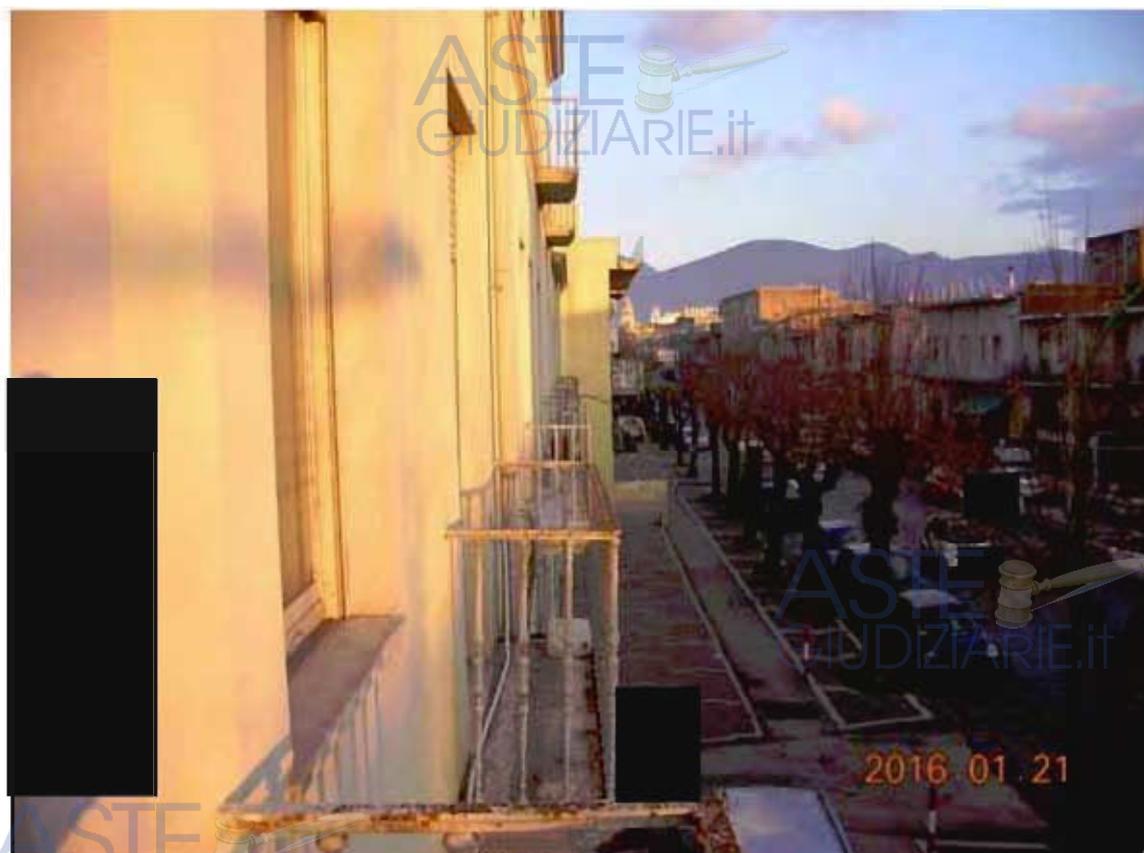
Dall'immobile Sub 5: vista su Via Nazionale delle Puglie
